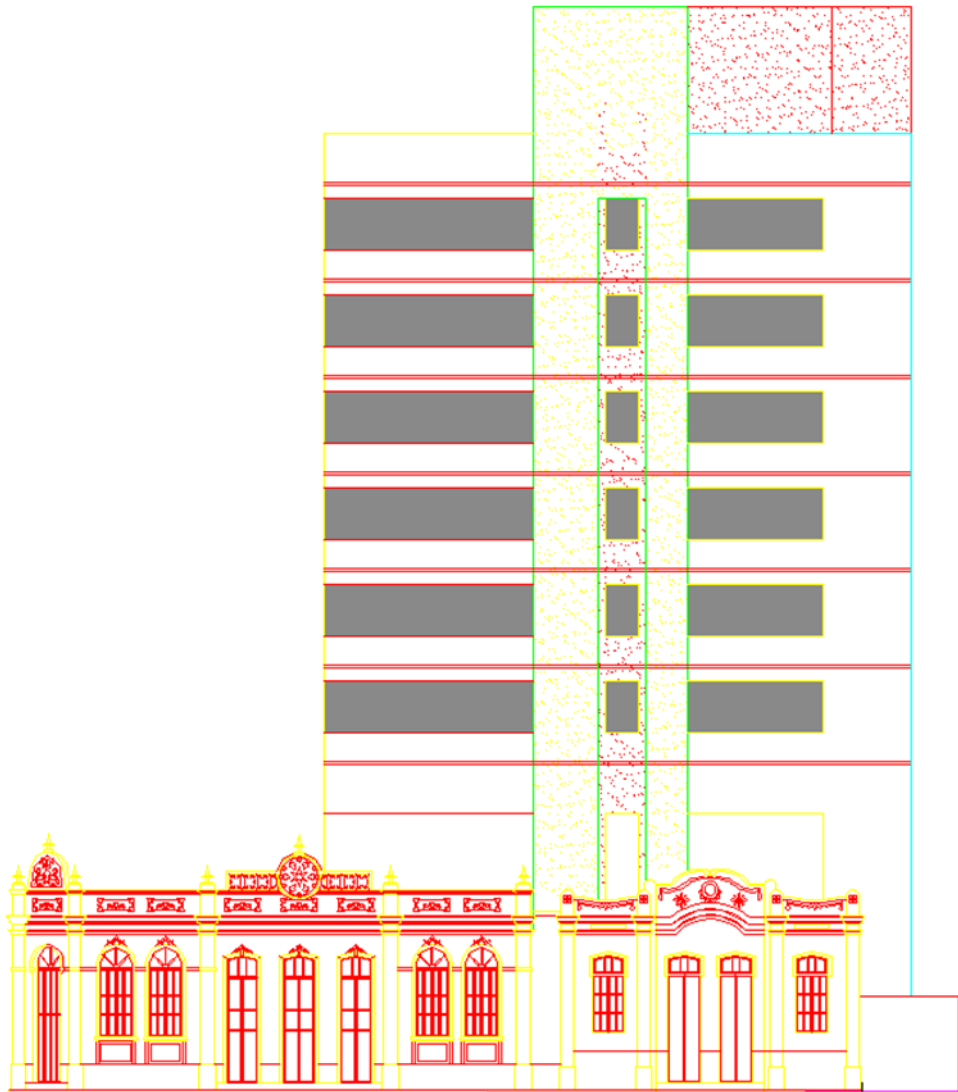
Fachada Travessa João Carlos Belo Lisboa.
